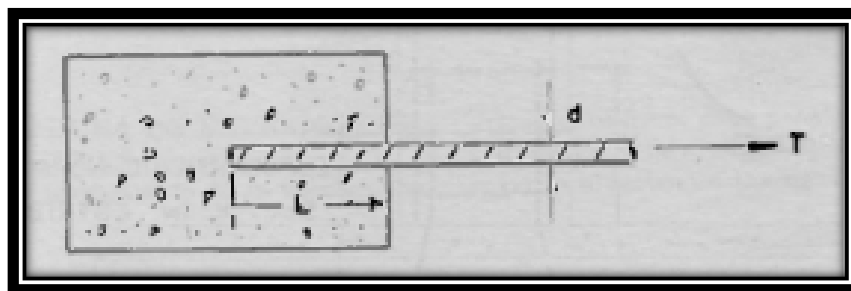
Longitud de anclaje para adherencia del acero con el concreto
